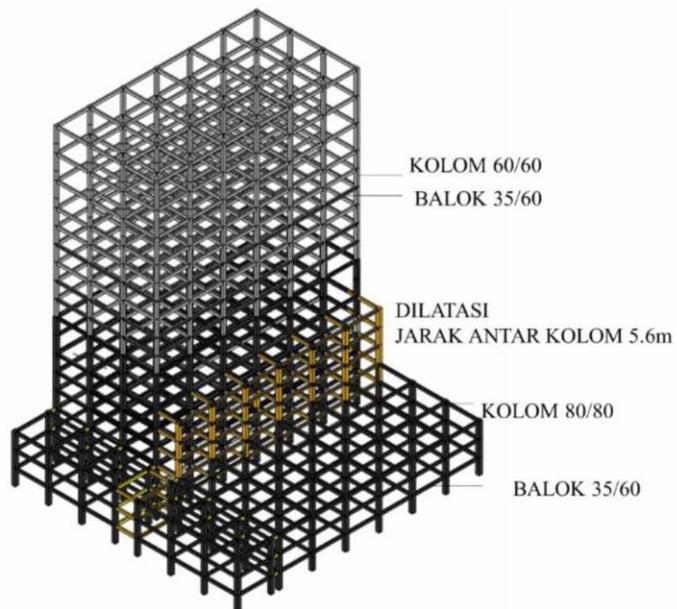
Denah Bangunan (Sintesa Penulis, 2020)
